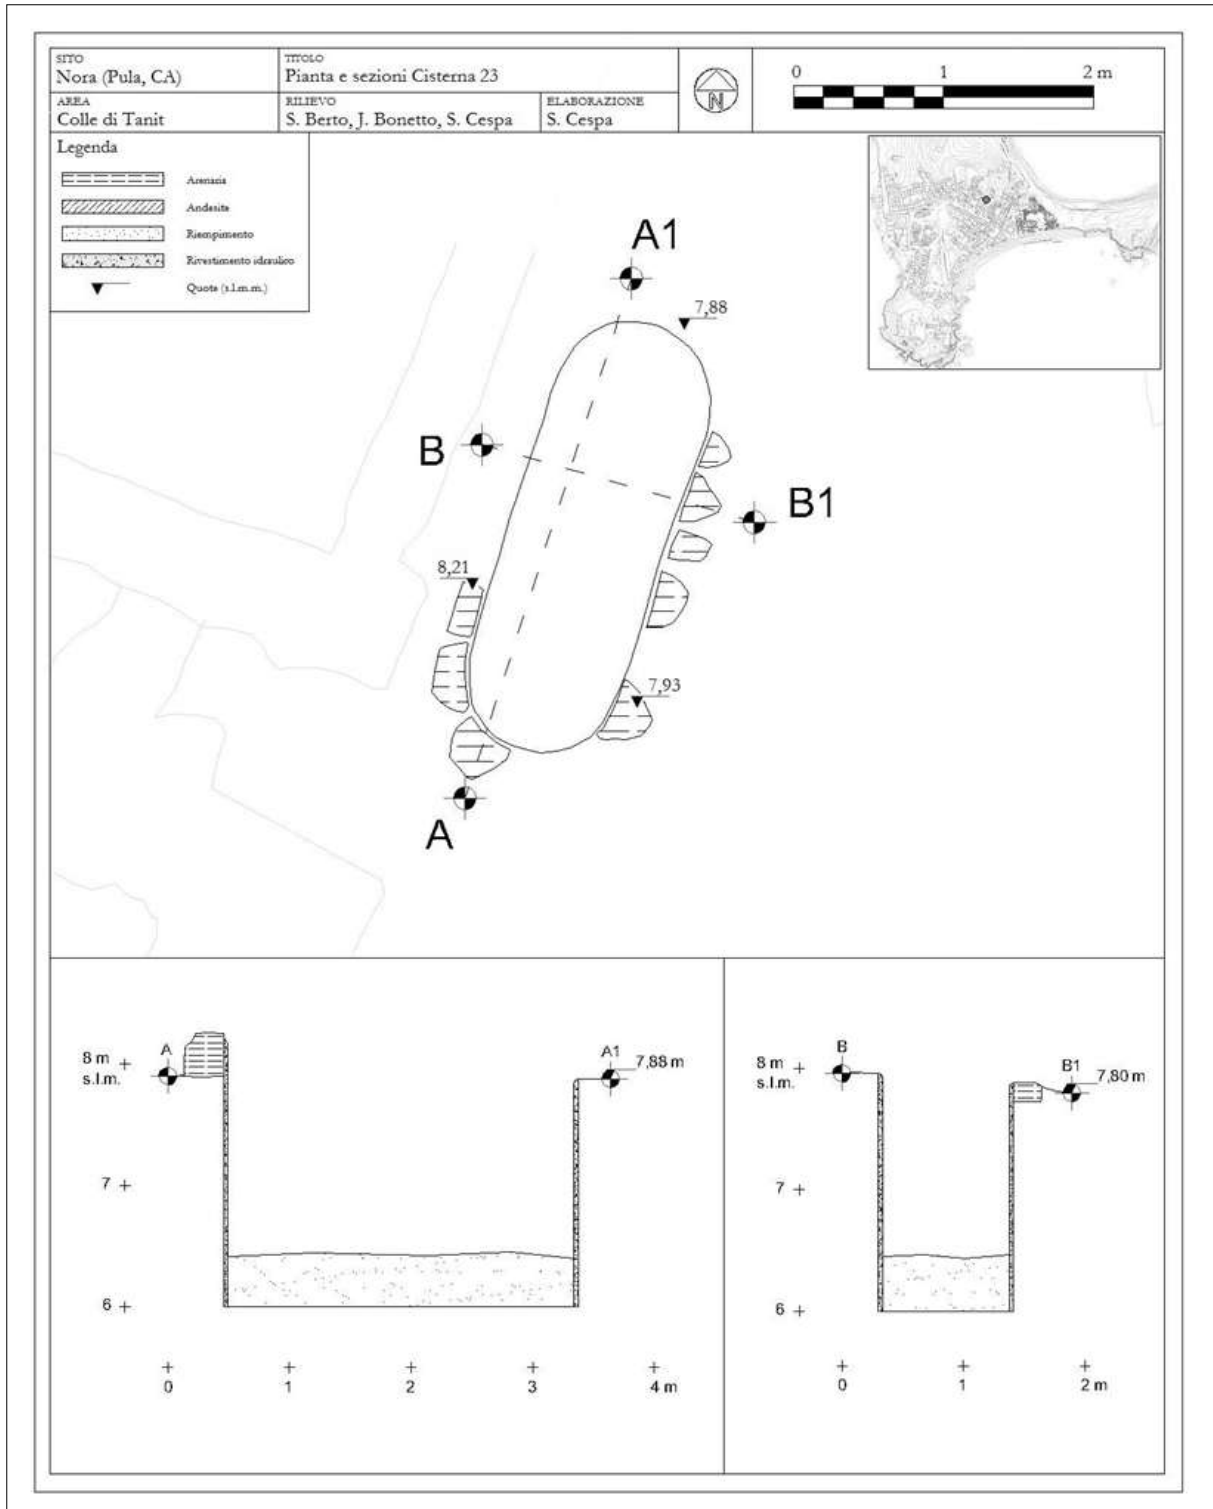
Pianta e sezioni della cisterna 23 (elaborazione dell'autore).
